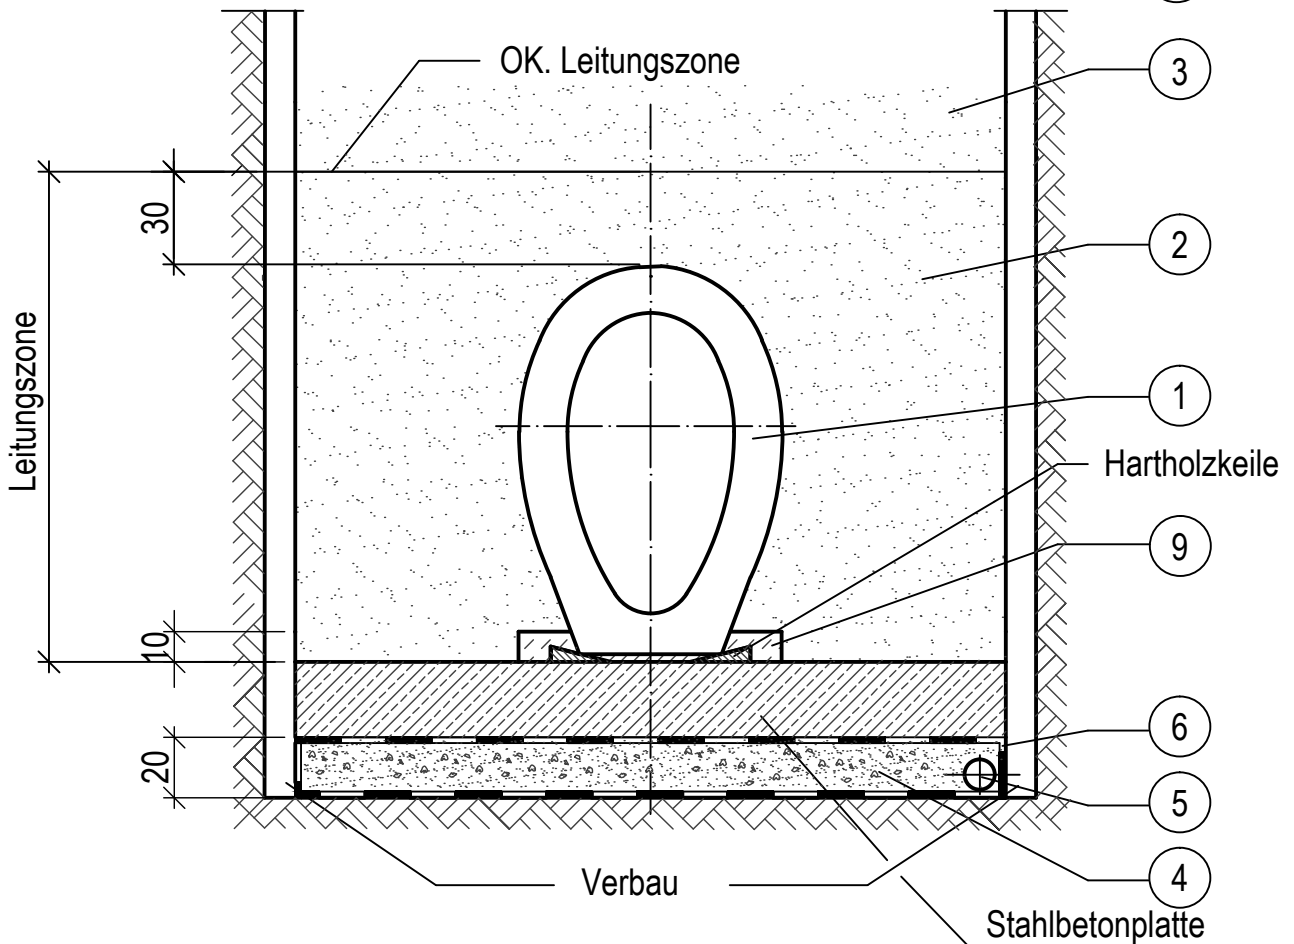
Ausführung mit offener Wasserhaltung, wenn Stahlbetonplatte aus statischen Gründen erforderlich (Maße in cm)
